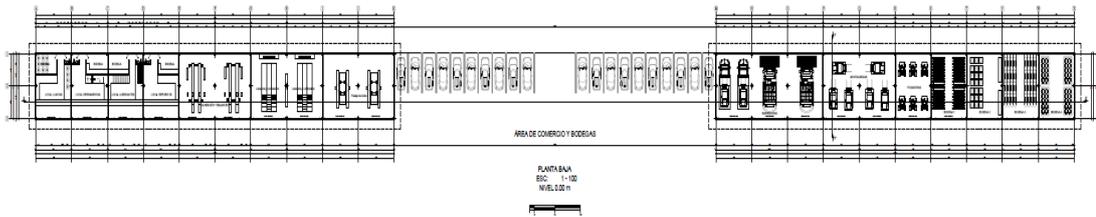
Planos arquitectónicos de revisión y bodegas
